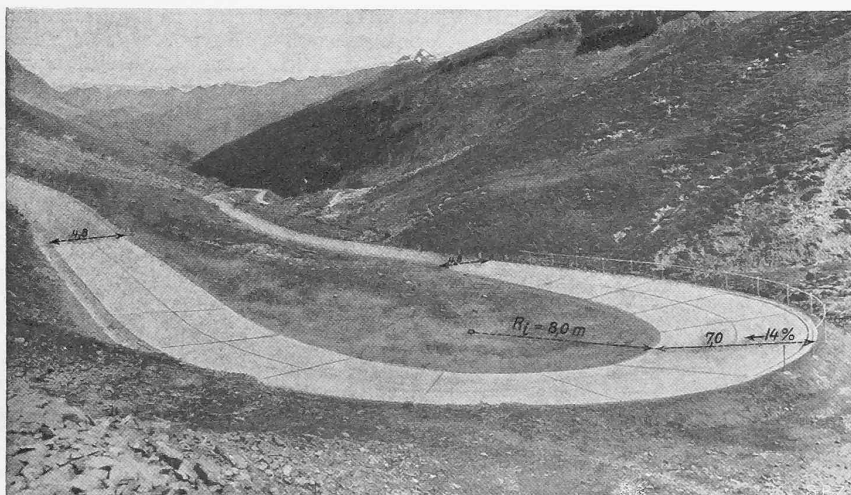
Betonkehre auf dem «Säuboden» an der Klausenstrasse, Kt. Uri (Glernerseite).
